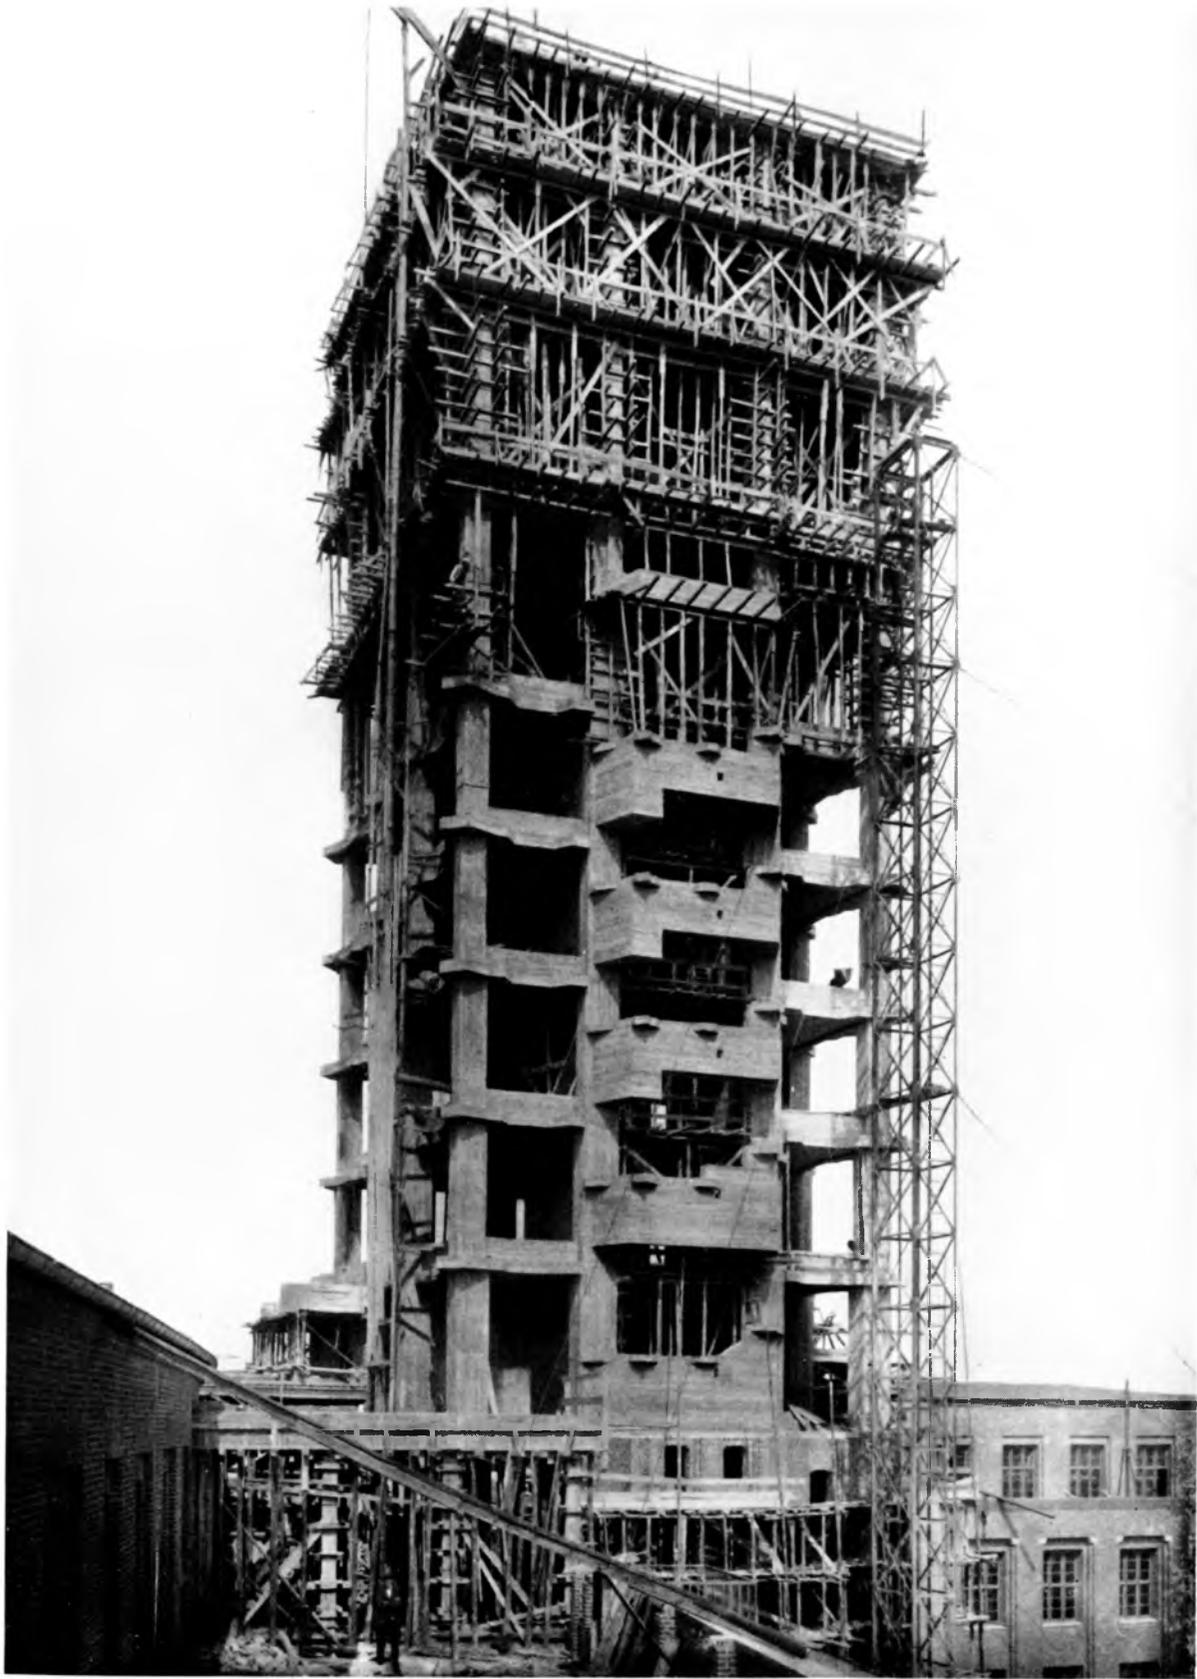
Eisenbetongerüst des Turmes. VII. bis XI. Obergeschoß ausgeschalt, XIII Obergeschoß in Schalung
